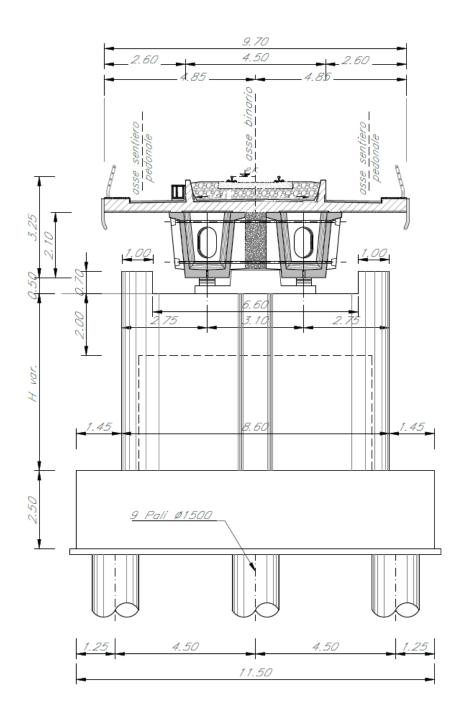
Pila scatolare singolo binario – prospetto trasversale
